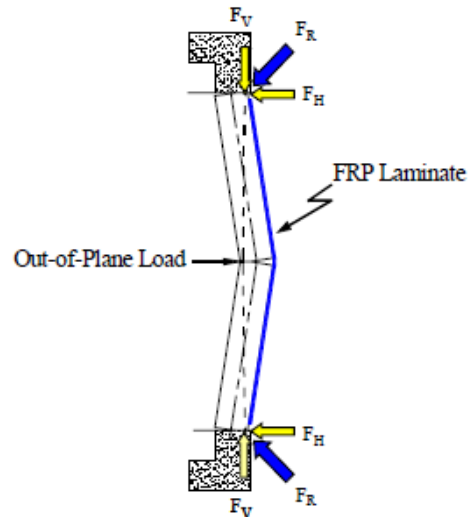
Modelo de ensaio em muretes de alvenaria [37]
